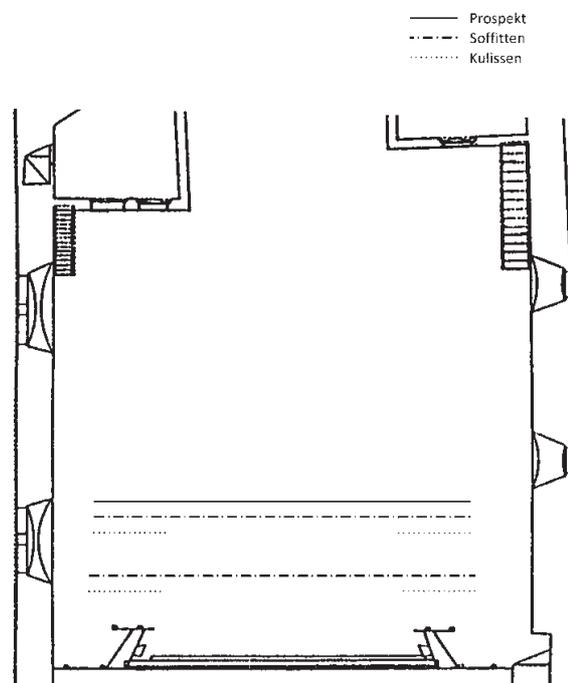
HANS WETSCHL und LEO MÄRKEL, Kerkerdekoration, Grundrissplan, 1766/67, Český Krumlov, Schlosstheater (Foto: Archiv Schloss Český Krumlov)
